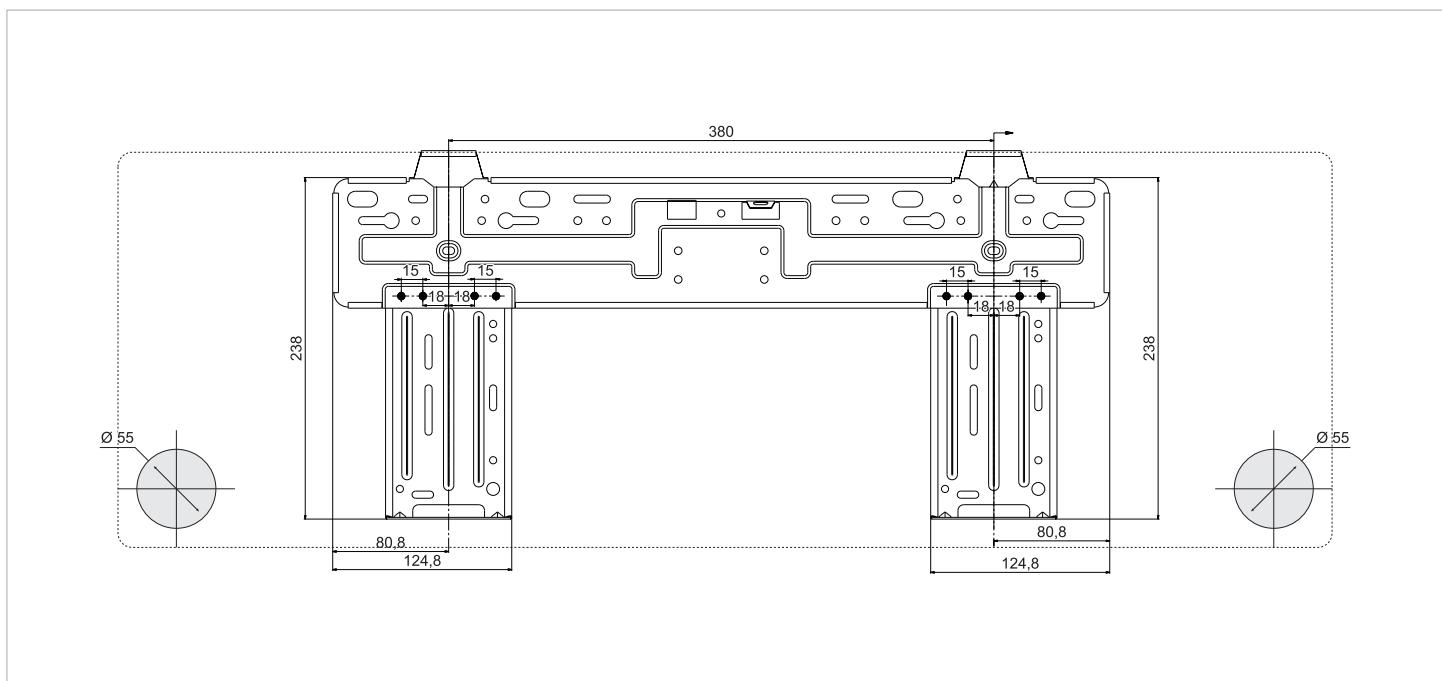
Placa de montaje para 17-035 NMWI.
